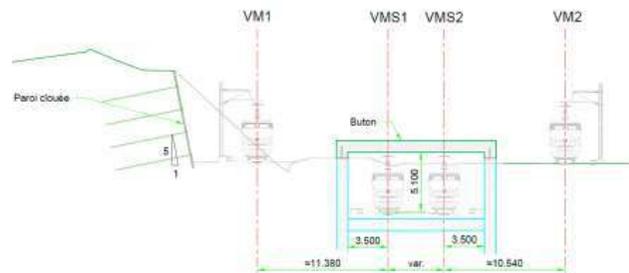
Profil en travers – tranchée ouverte (EGIS, 2021)
